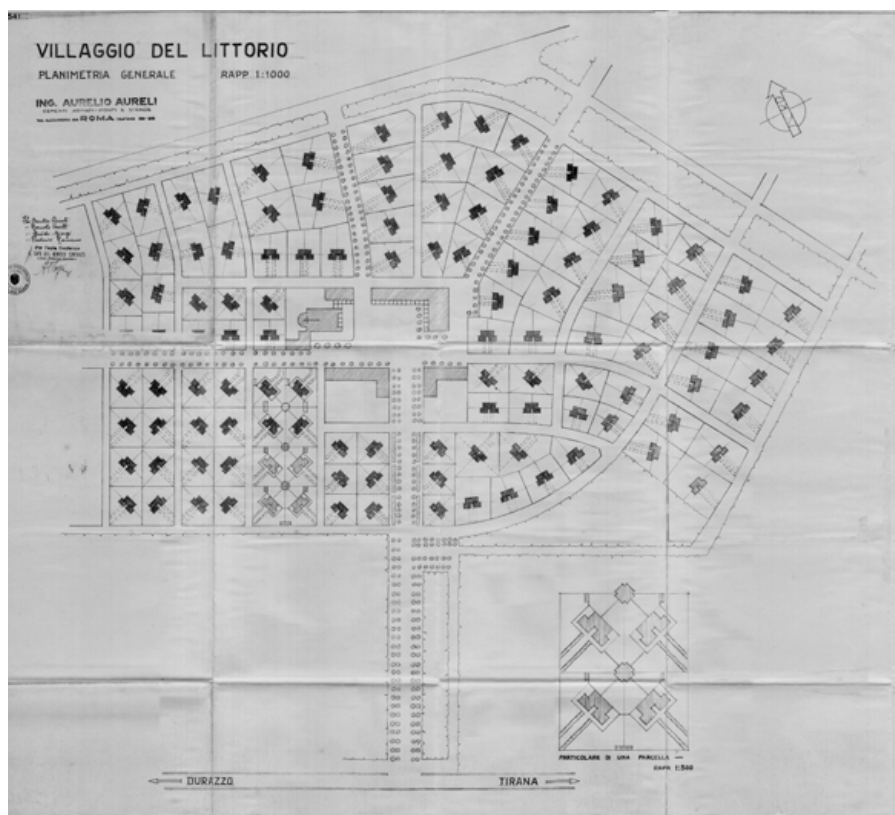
Planimetria e divisione del lotto (AQTN)
